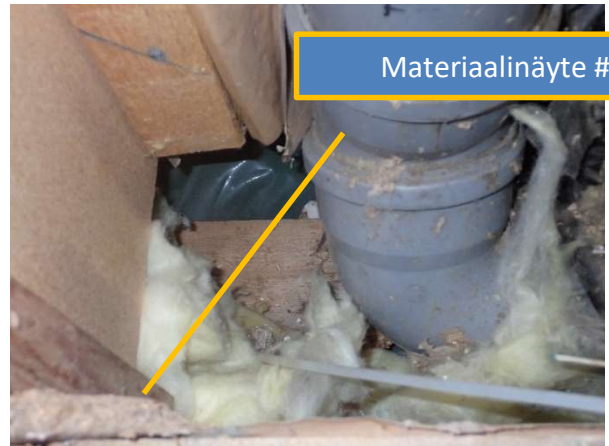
Pohjalla olevan laudan pinta aistinvaraisesti havaittavissa mikrobivaurioita
